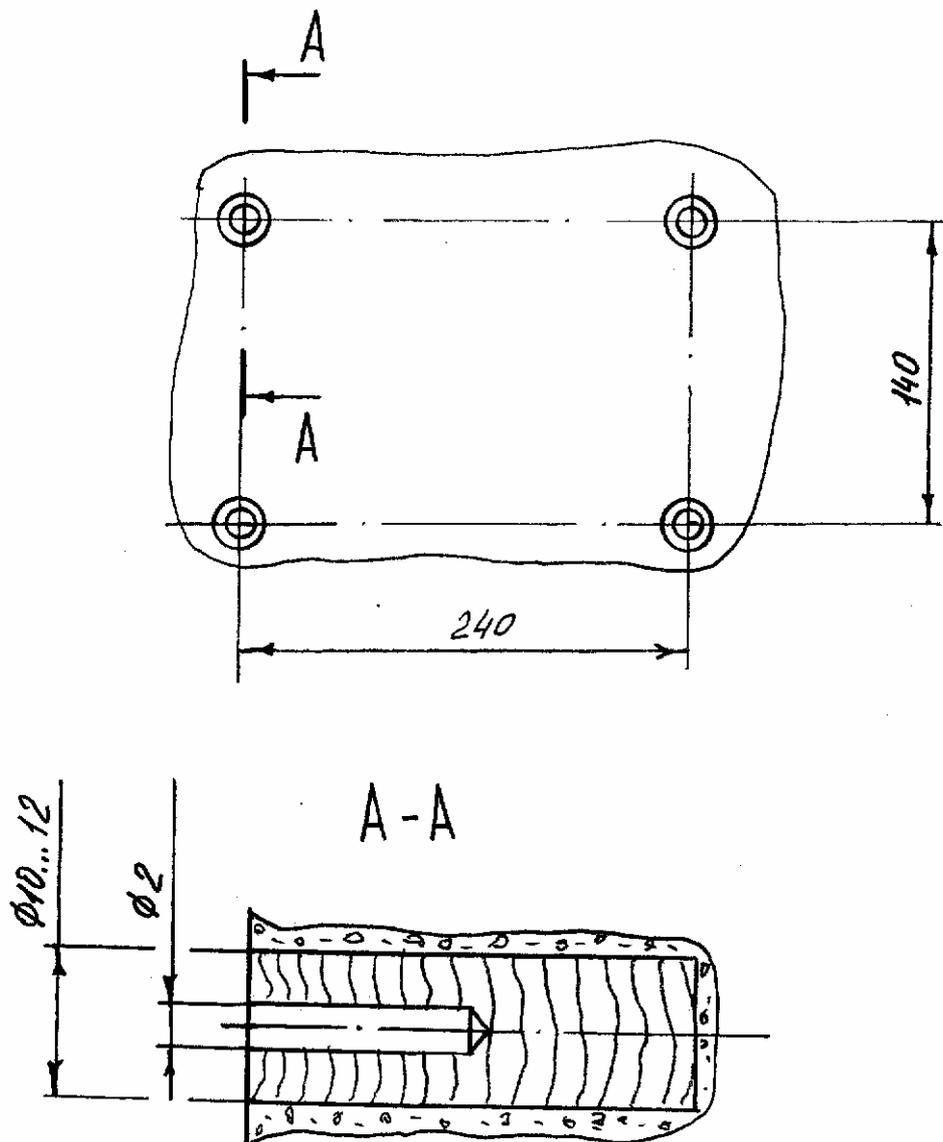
Разметка отверстий под установку изделия Фокус-СМ.
